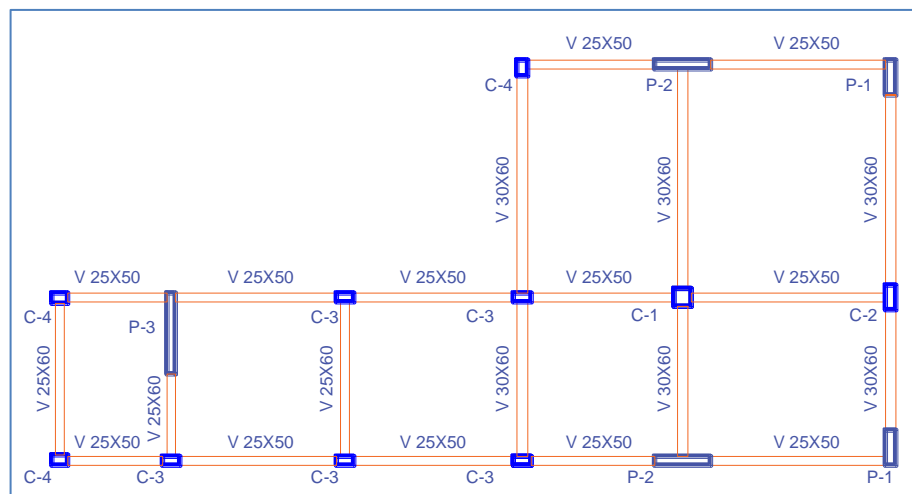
Vista en planta de la configuración del sistema estructural Dual Fuente propia
